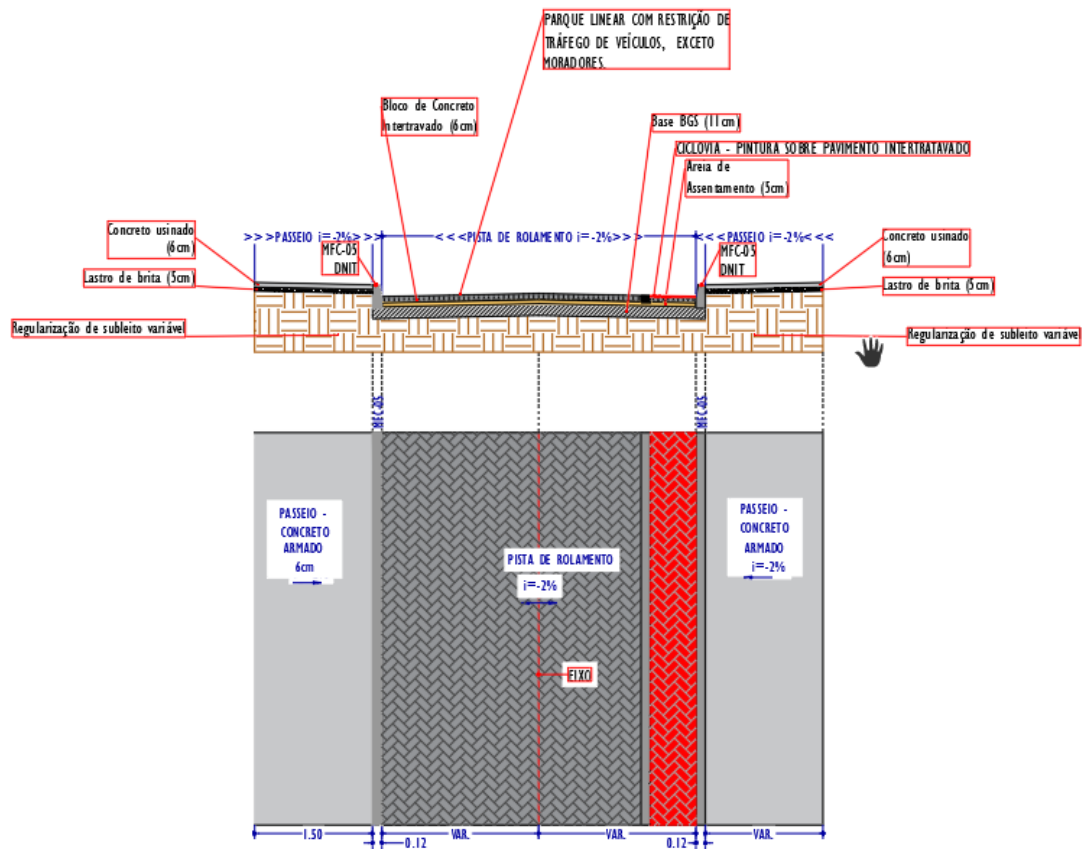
SEÇÃO TÍPICA DE PAVIMENTO EIXO 03
